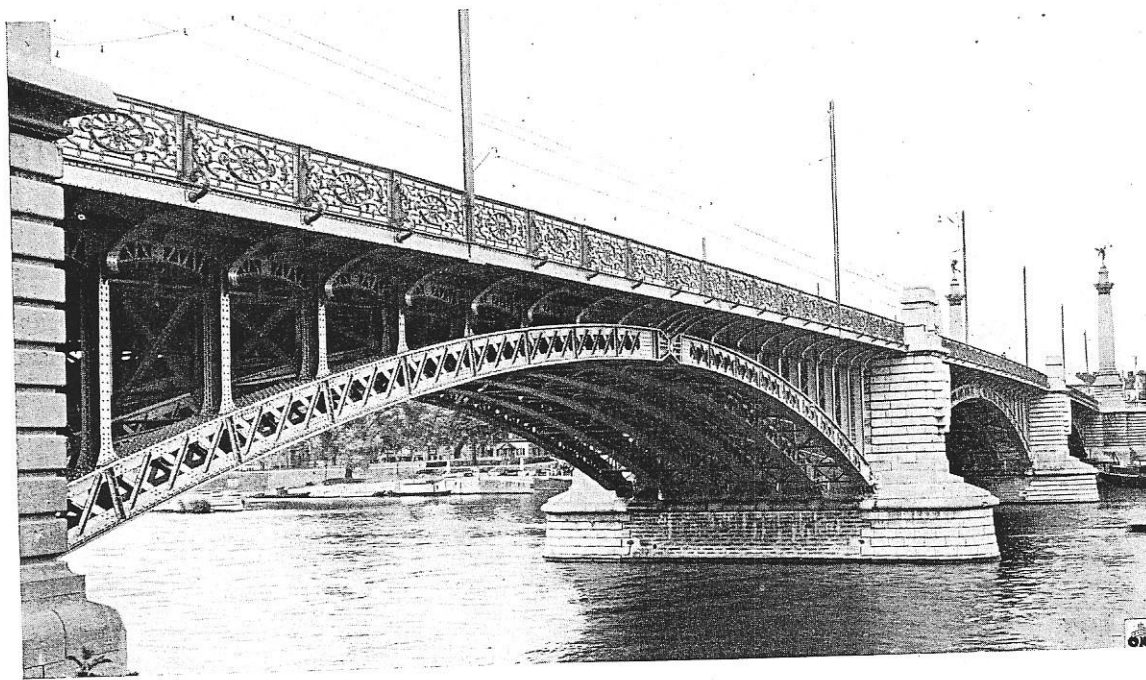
Vue d'ensemble du nouveau pont de Fragnée à Liège.
